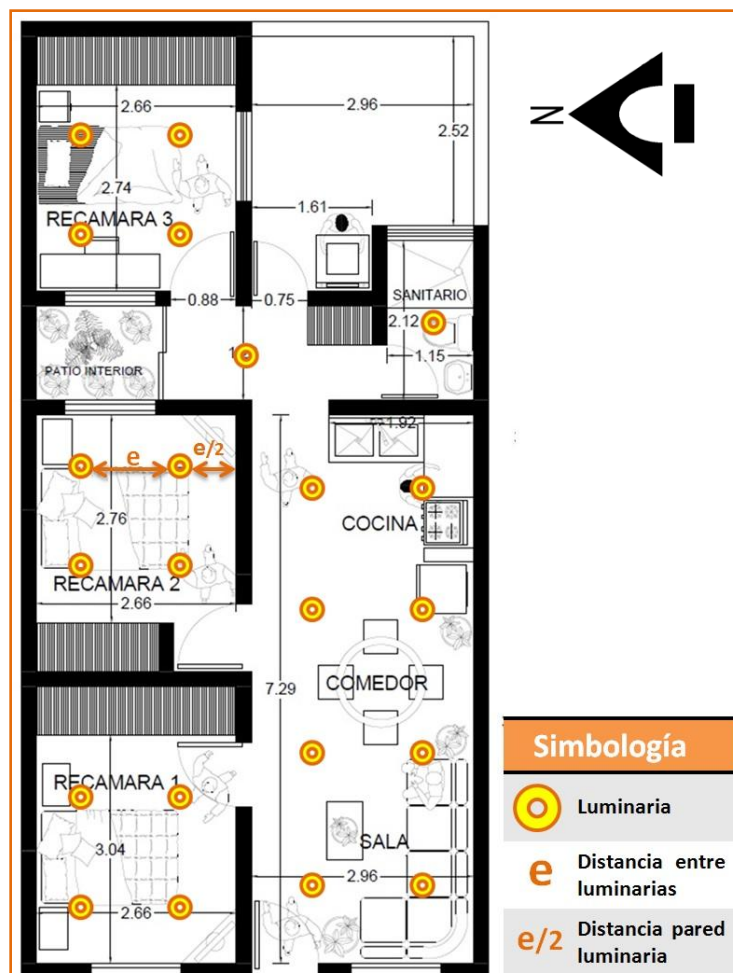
Plano de distribución de luminarias en la vivienda de interés social del primer caso de estudio. Fuente Propia.
